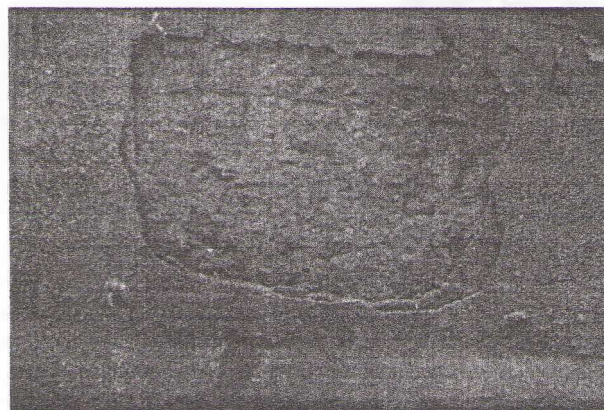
Повреждение защитного слоя железобетонной конструкции
